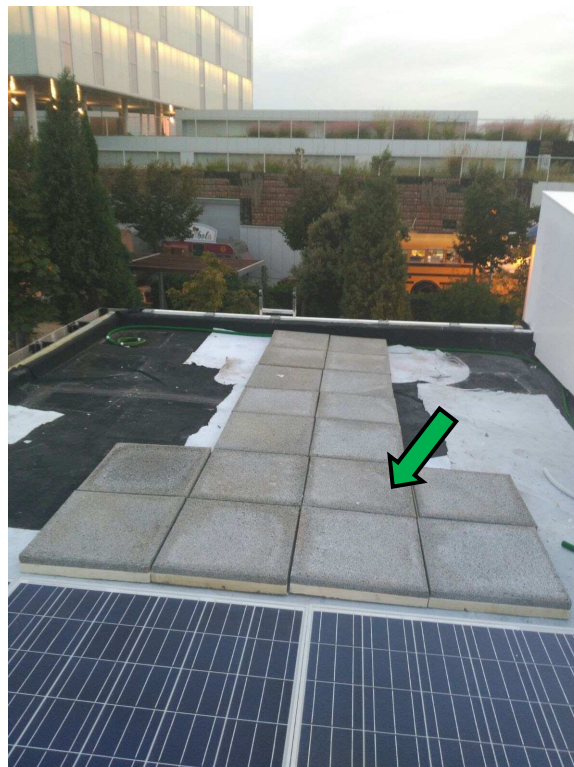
Protección de la zona de acceso por mantenimiento a la cubierta / [EBH16]
